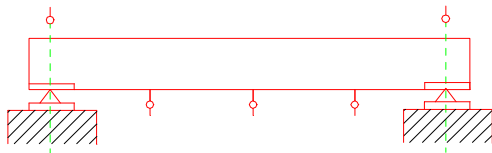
受弯构件挠度曲线量测测点布置
